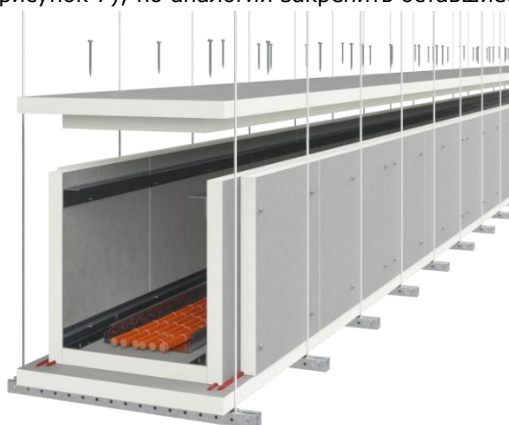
Крепление примыкающей стенки из плит к уголку при помощи саморезов
